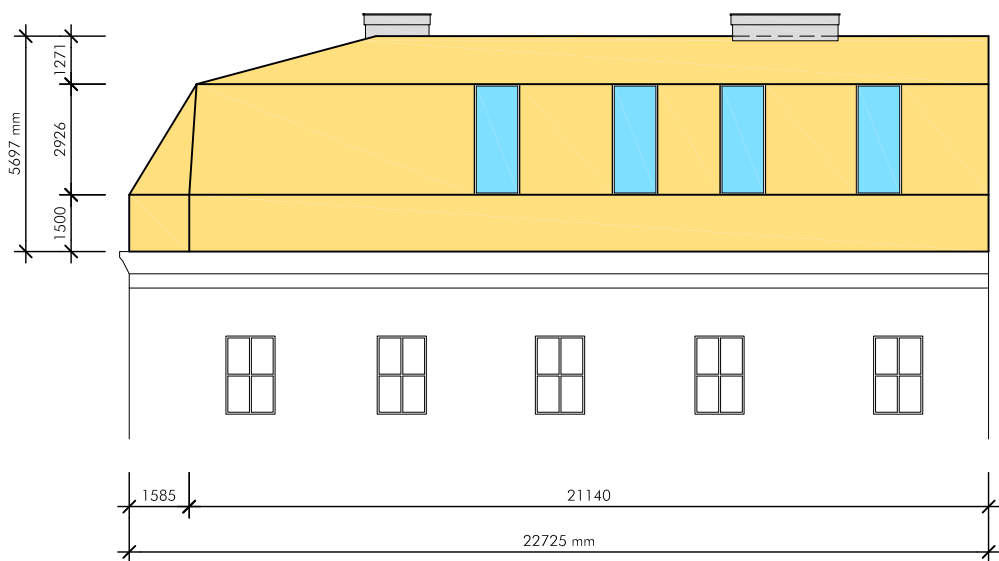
Ansichten M 1:200 (alle Maße in mm)
